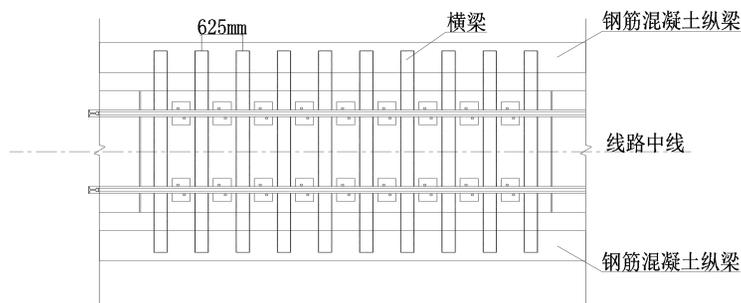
采用钢筋混凝土纵梁的D型便梁架空间距为625mm平面示意图
